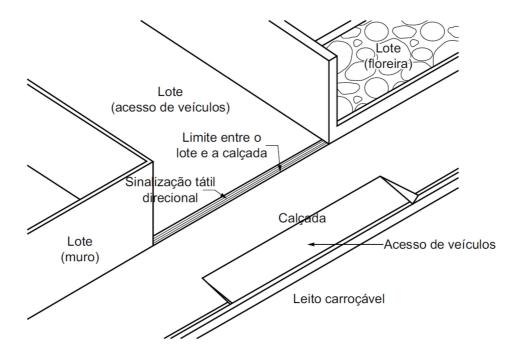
Alinhamento de lote não edificado, entre outros lotes edificados. Fonte: NBR 16537/2016.
